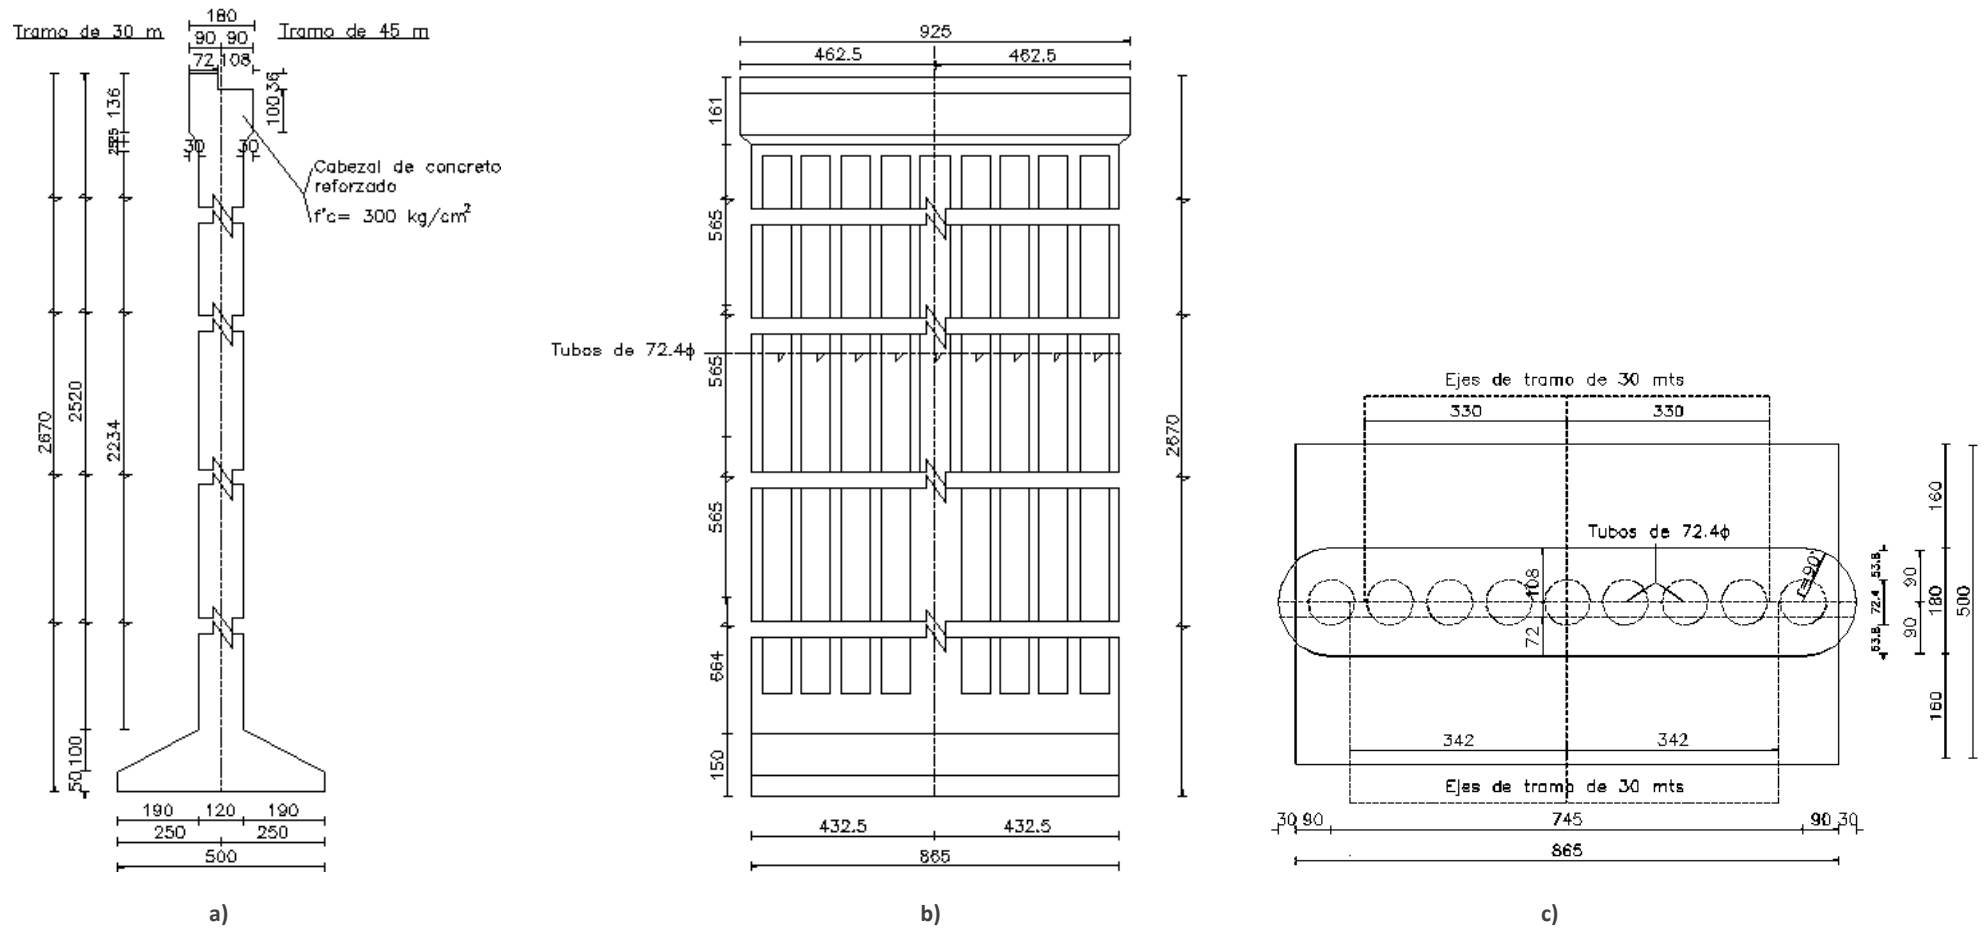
Dimensiones generales de la pila central del puente Barranca del Muerto: a) Elevación lateral; b) Elevación frontal y; c) Vista en planta. (Sin escala, cotas en cm).
